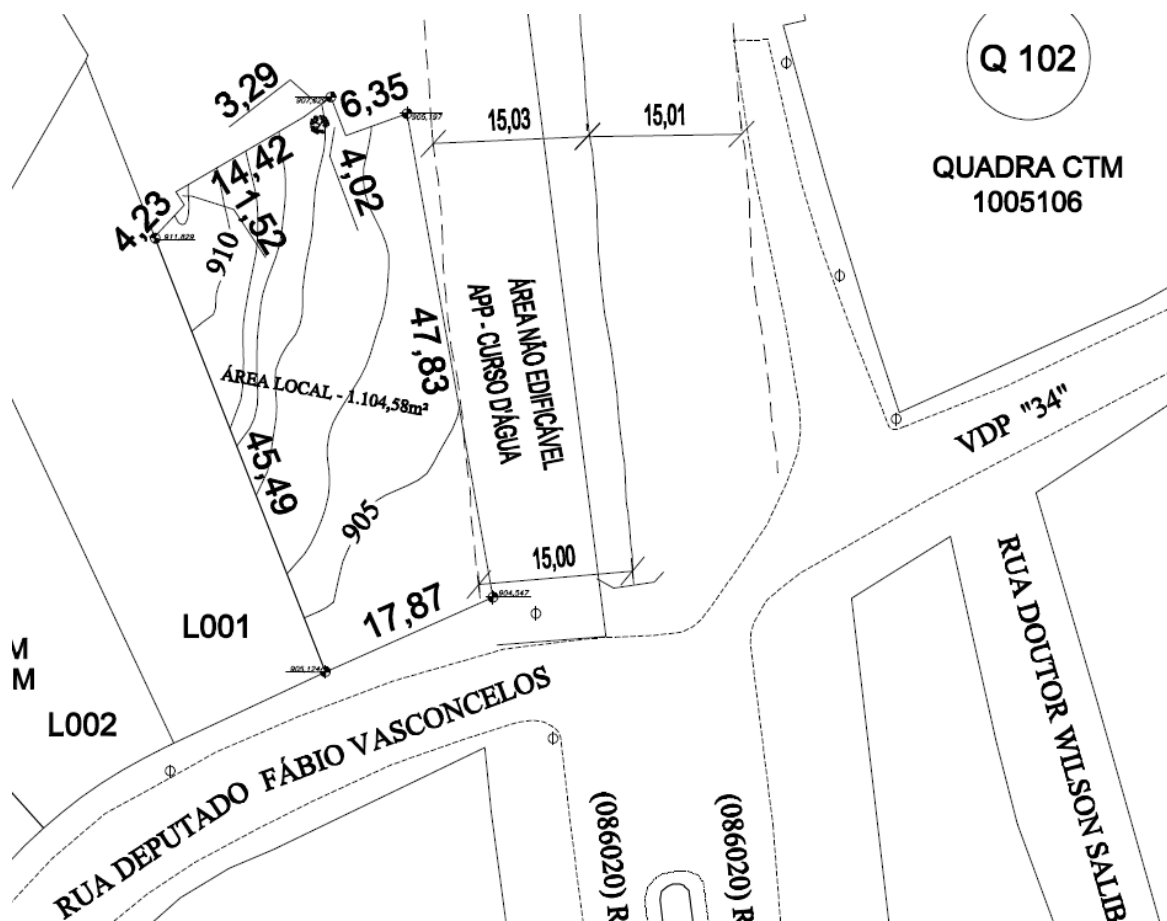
Detalhe do levantamento planialtimétrico apresentado destacando a região do lote e sua proximidade com o recurso hídrico
